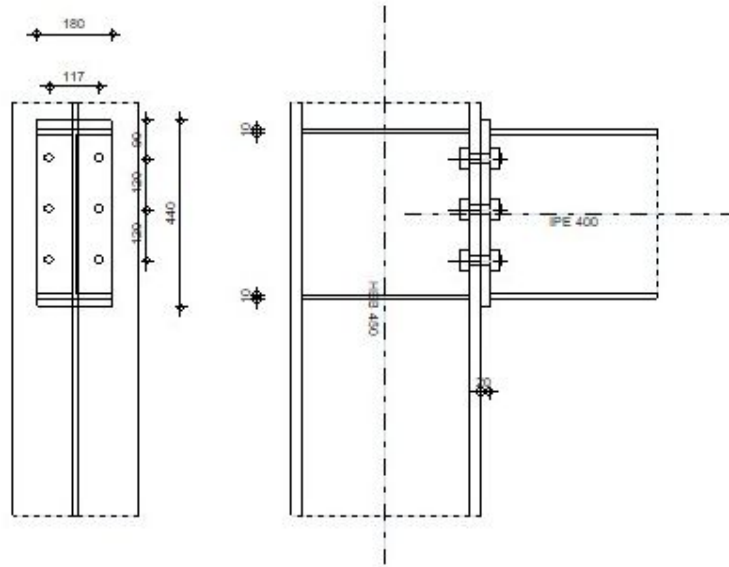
Assemblage Poteau-Poutre par platine.
